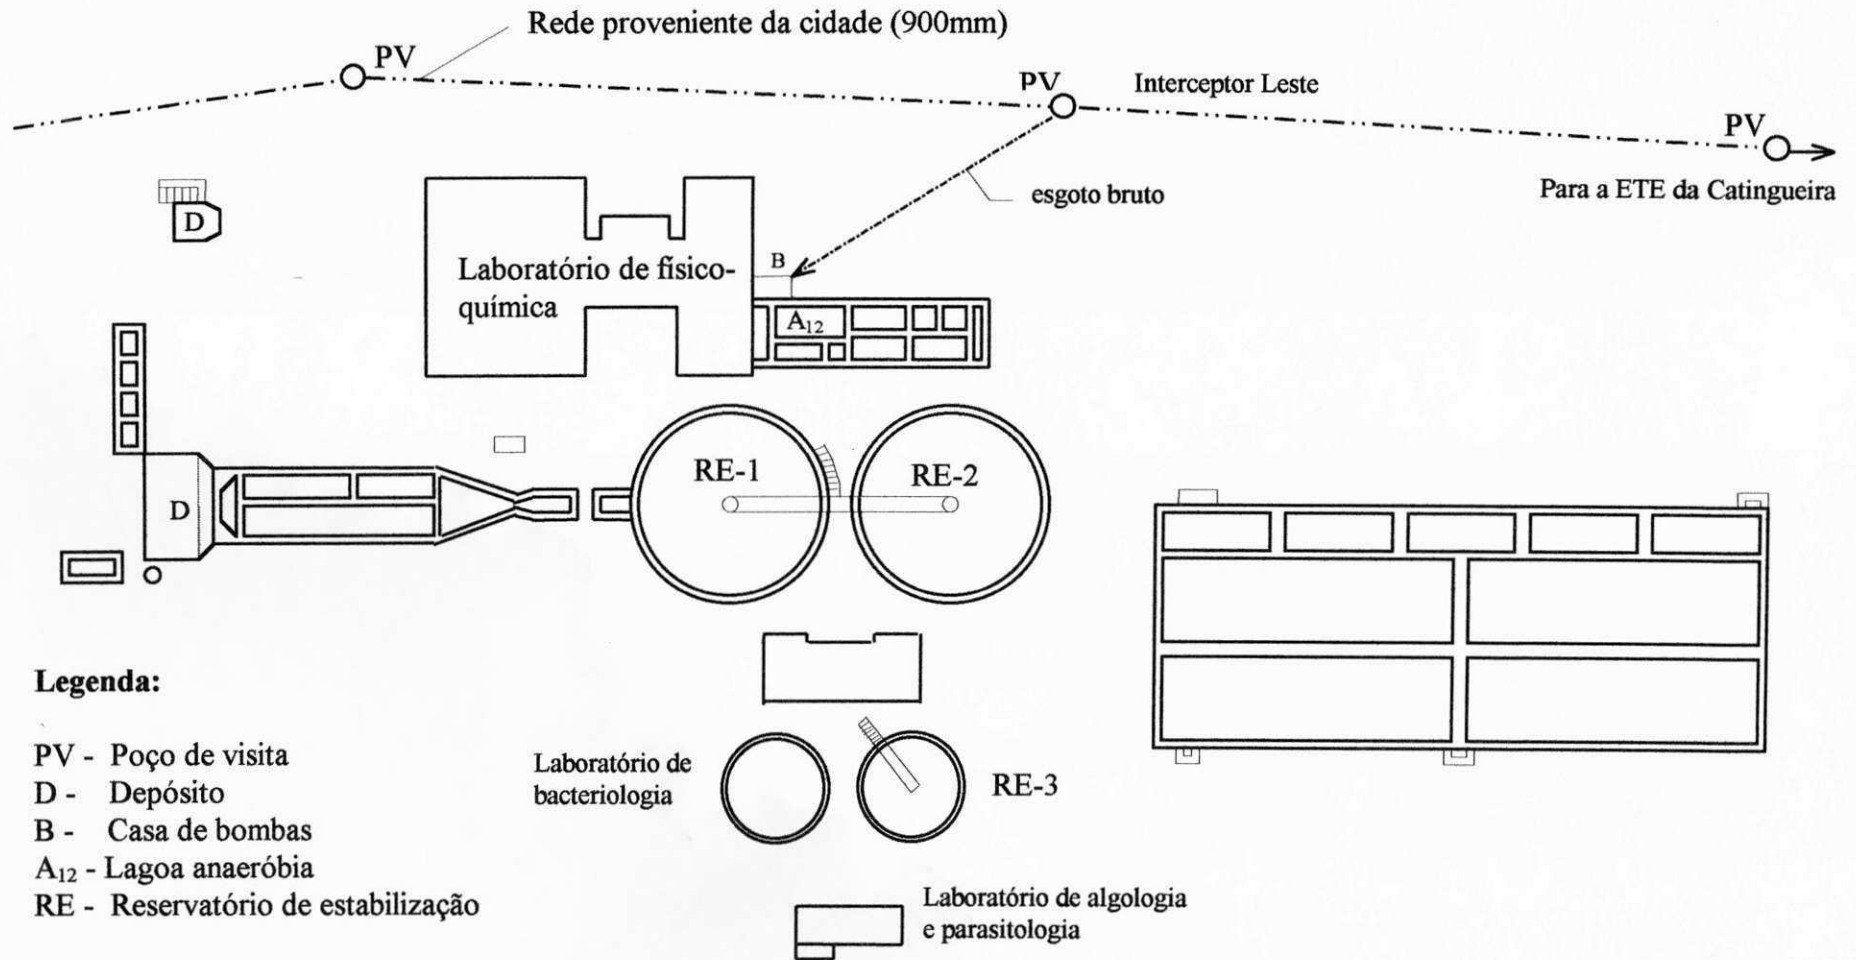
Planta de situação do complexo experimental da EXTRABES.
